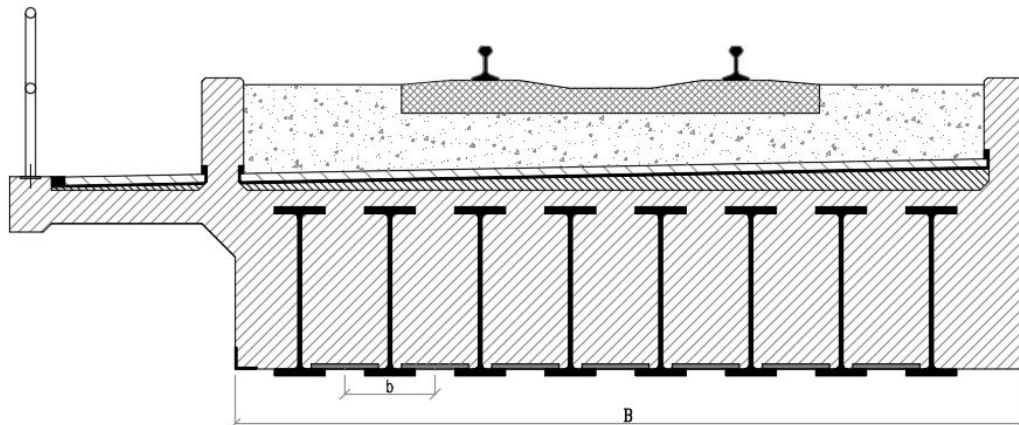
1 – Secțiune transversală pod cu grinzi înglobate în beton
